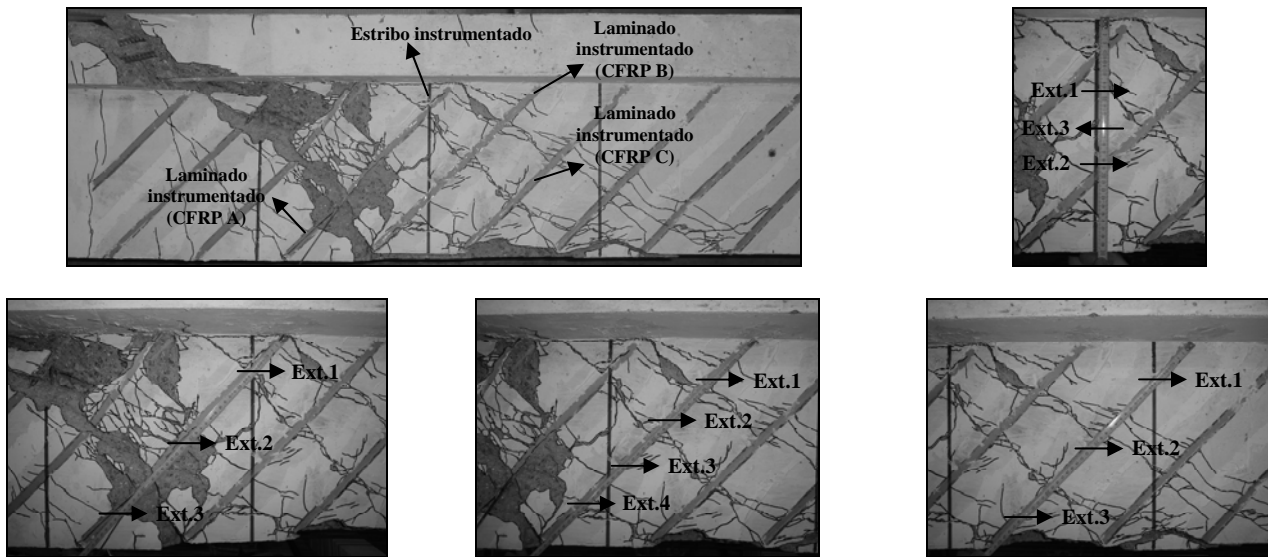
Localização dos extensómetros no laminado e estribo instrumentados da viga 3S-9LI45-D.
